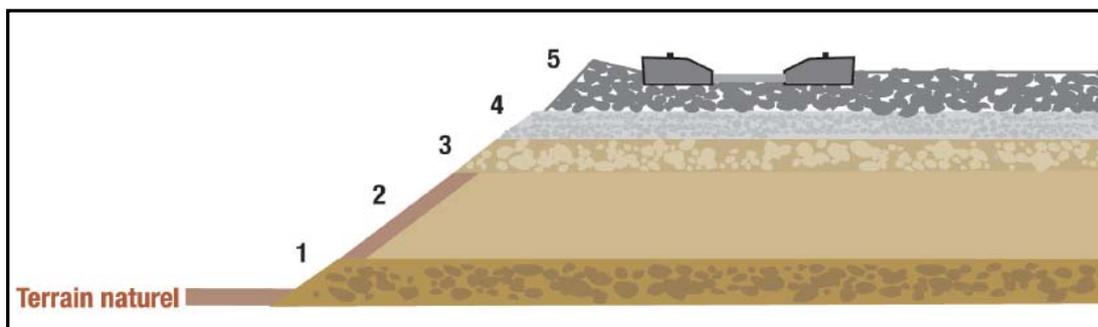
Coupe type sur plate-forme LGV en remblai\
